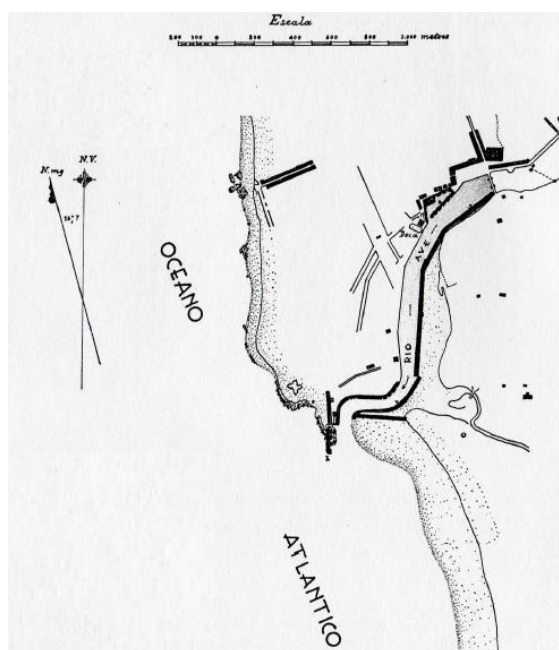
Planta do porto de Vila do Conde, 1937. [3]
